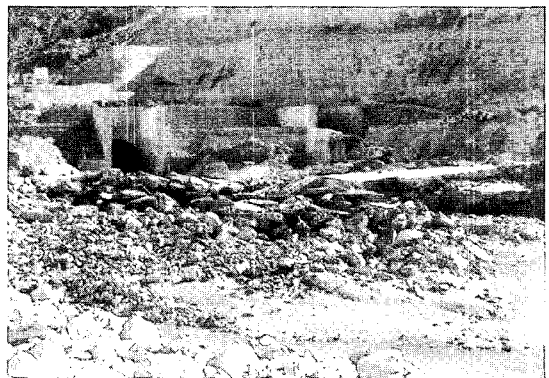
Concrete Block이 DTR Outlet으로 씻겨져 나온 모습
